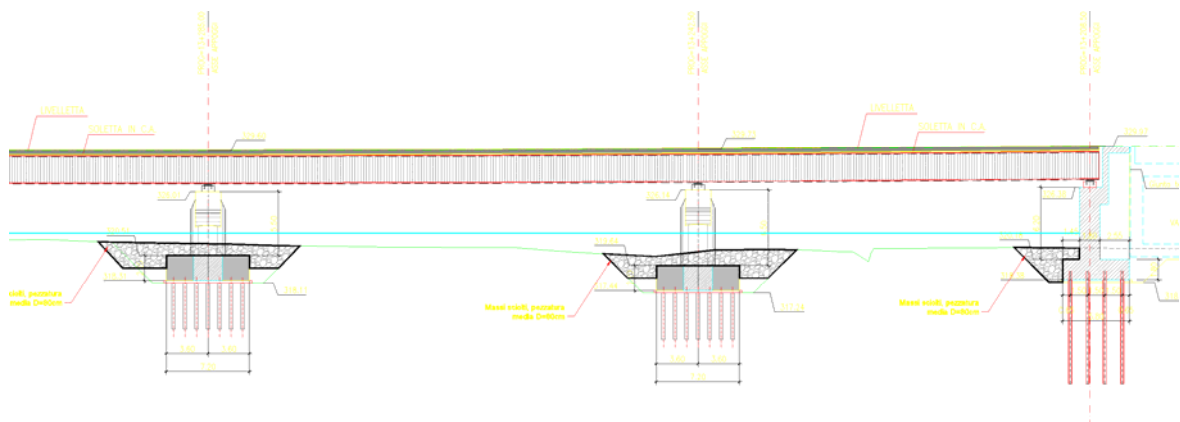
Viadotto Settecà protezione pile 2, 1 e spalla lato Sud, viadotto Nord
